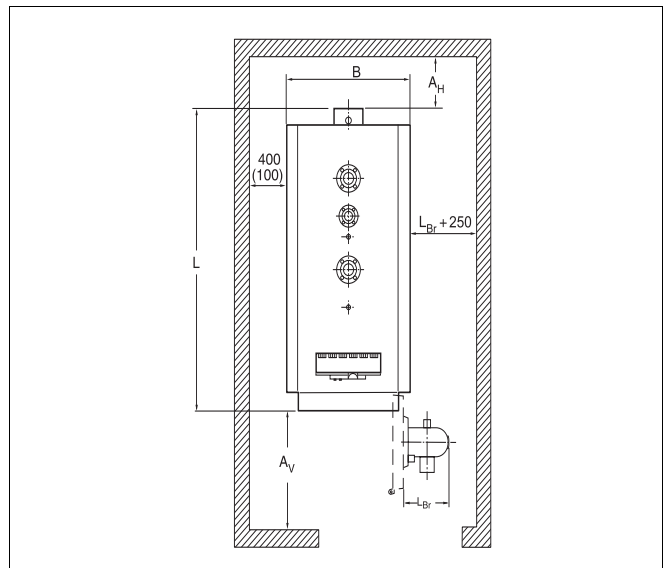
Local d'installation avec chaudière (positionnée à gauche) Dimensions en mm
